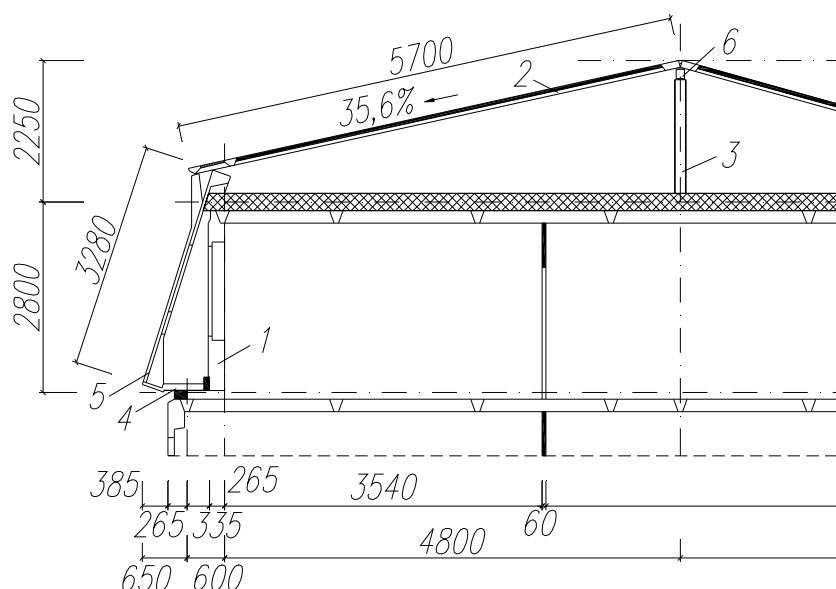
Пример сборной железобетонной крыши мансардного типа с наружным водоотводом и вертикальной фризовой стеной из утепленных панелей в зданиях с поперечными несущими стенами (Германия) [6]:
